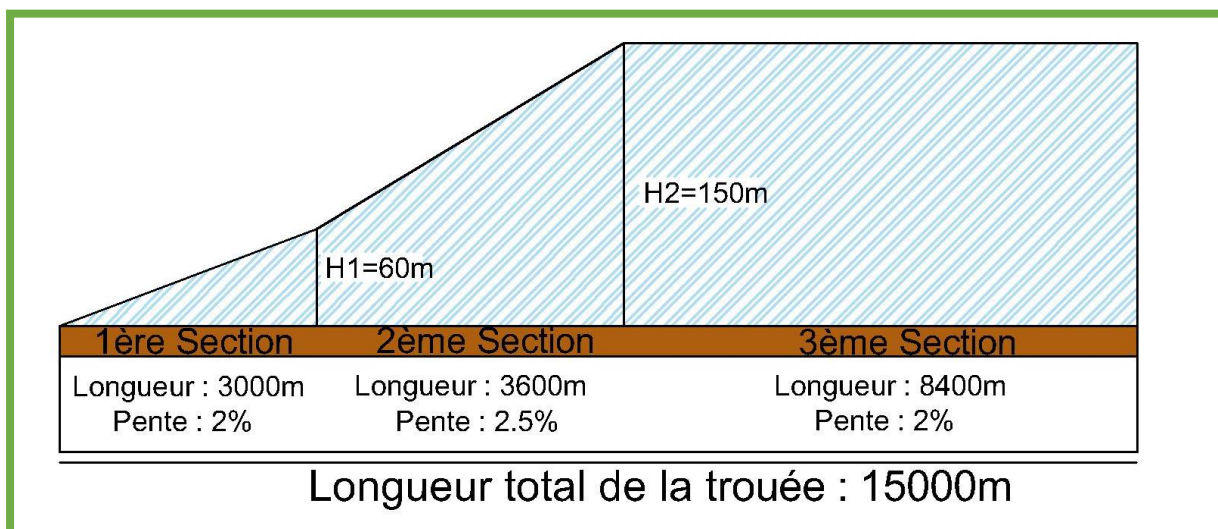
Coupe longitudinale de la trouée d'atterrissage.
